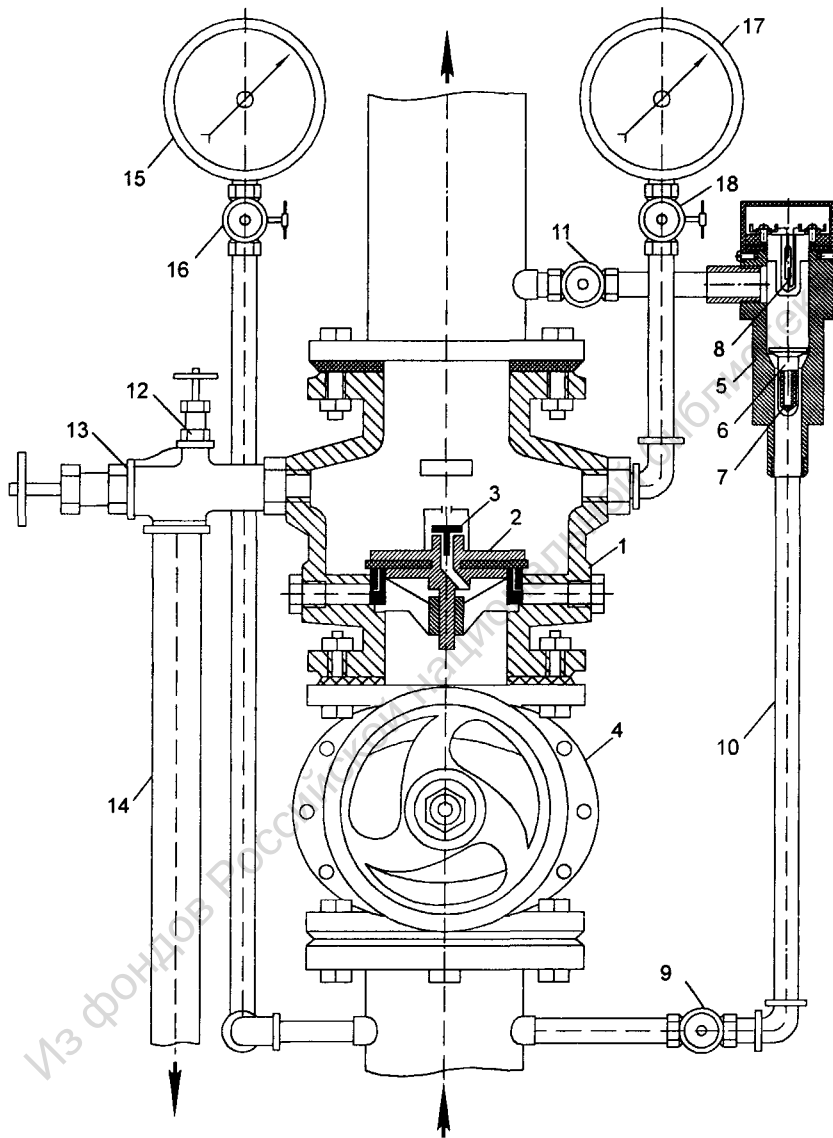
Схема новой конструкции КПУ: 1 – контрольно-сигнальный клапан; 2 – тарель; 3 – компенсатор; 4 – задвижка; 5 – сигнальное устройство ВСМ; 6 – плунжер; 7 – постоянный магнит; 8 – геркон; 10 – сигнальный трубопровод; 12 – малый вентиль; 13 – большой вентиль; 14 – сливной трубопровод; 9, 11 – краны пробковые; 15, 17 – манометры; 16, 18 – манометровые краны
